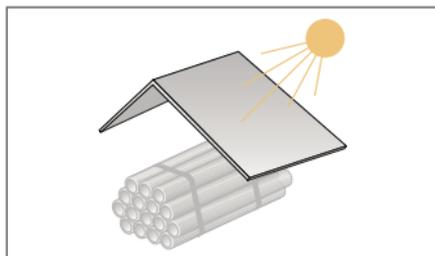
Protezione del tubo dall'impatto diretto dei raggi del sole
